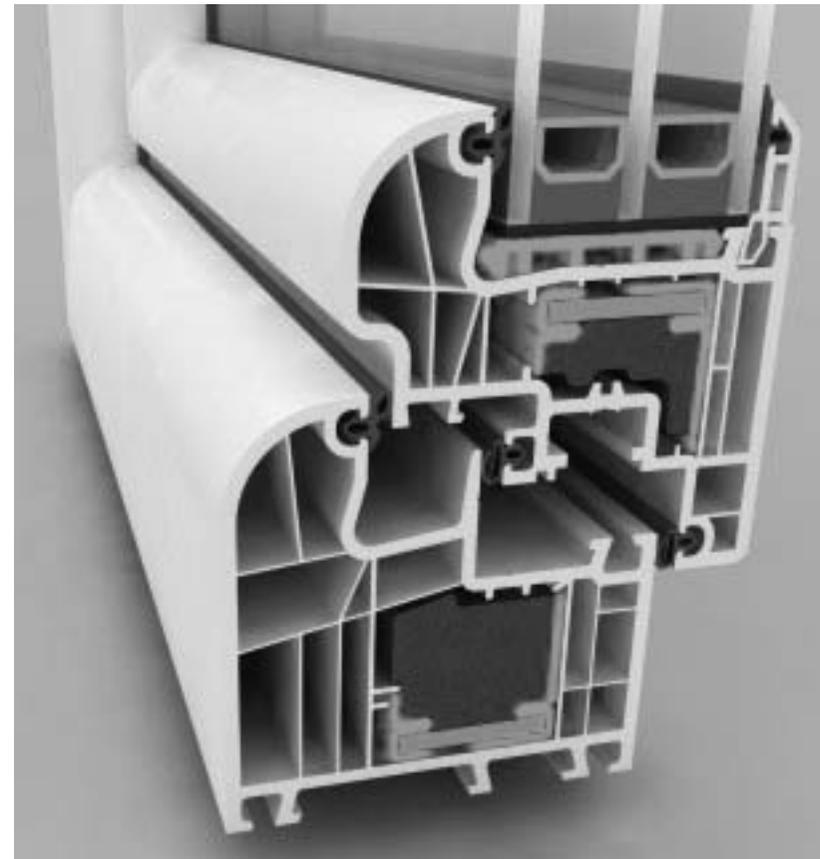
Profil eines Passivhausfensters mit Dreifach-Verglasung
